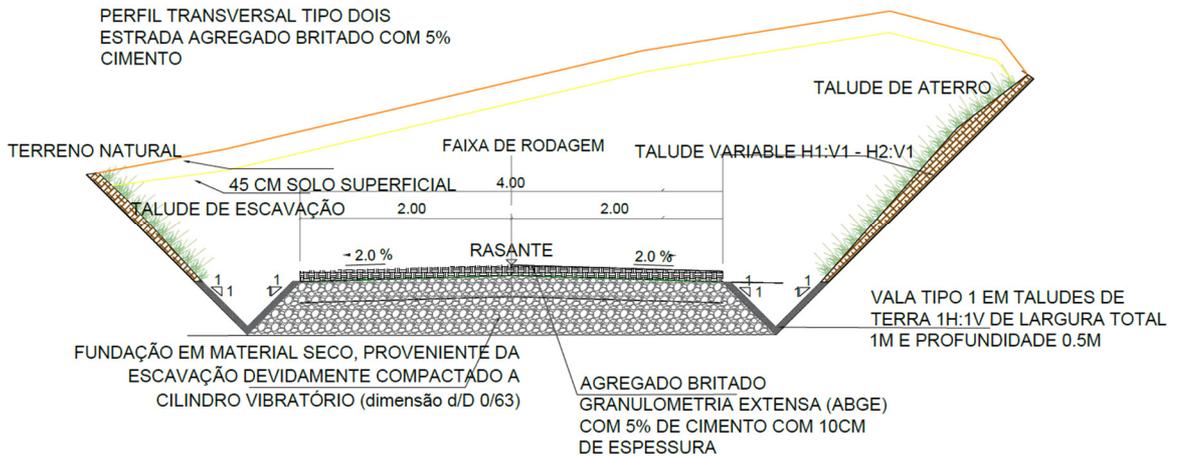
Perfil transversal tipo do Caminho de Acesso Interno agregado com 5% cimento
